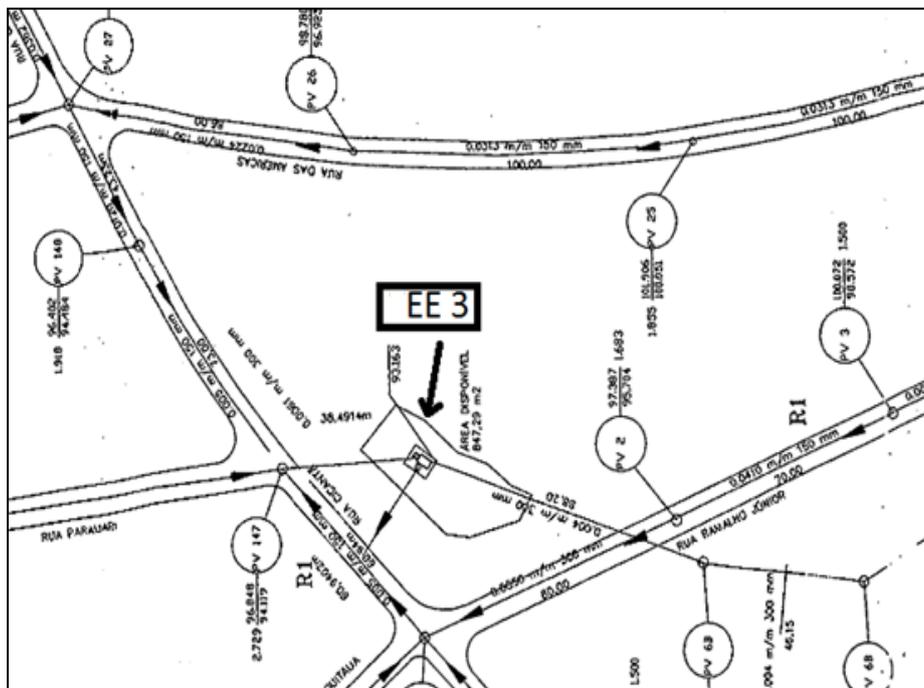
Localização da Estação Elevatória 3 - Rua Curuça, Bairro Mirante do Éden.
